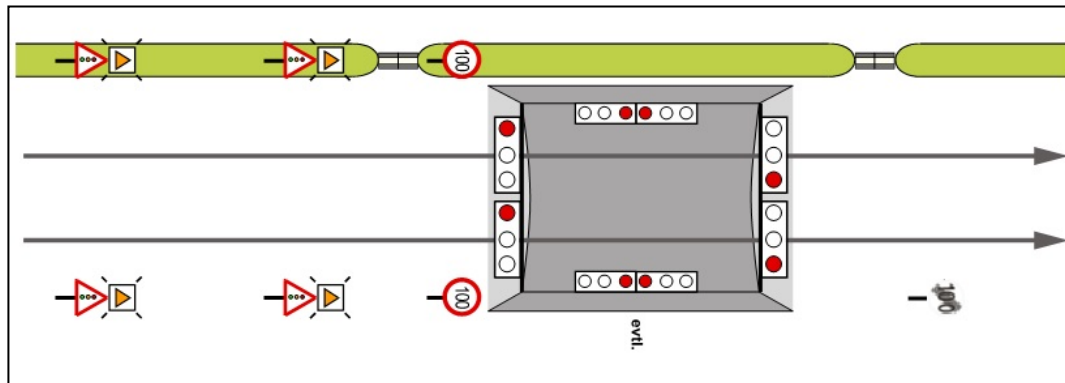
Plan de feux – Fermeture du tunnel.
